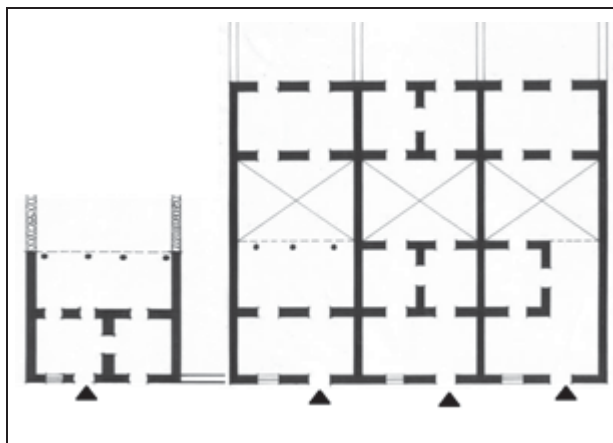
Plantas arquitectónicas de vivienda popular colonia (Grupo 3)
